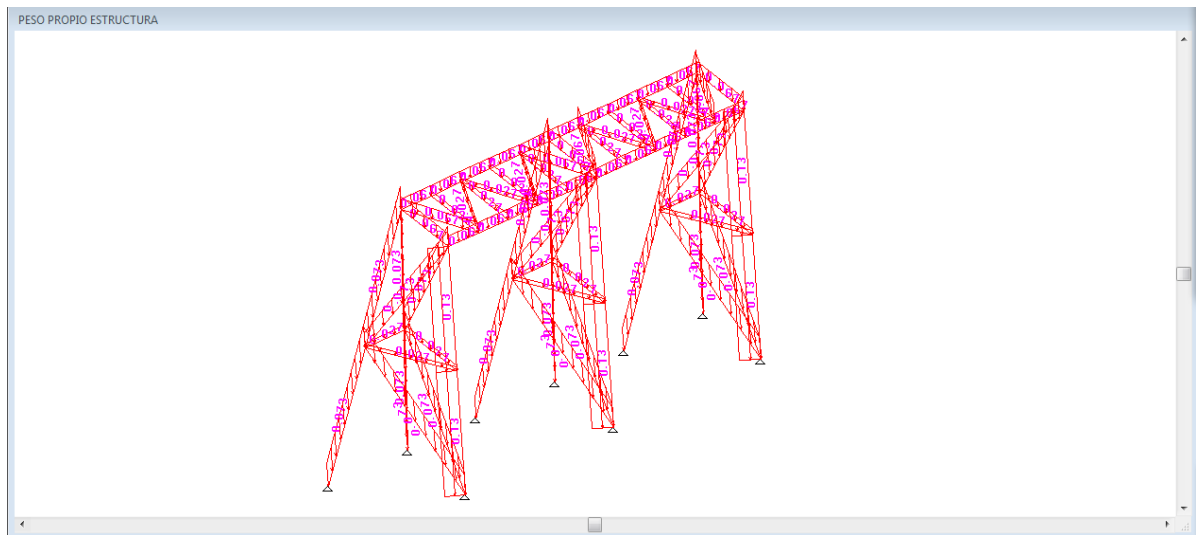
Estado de cargas 1: PESO PROPIO ESTRUCTURA
